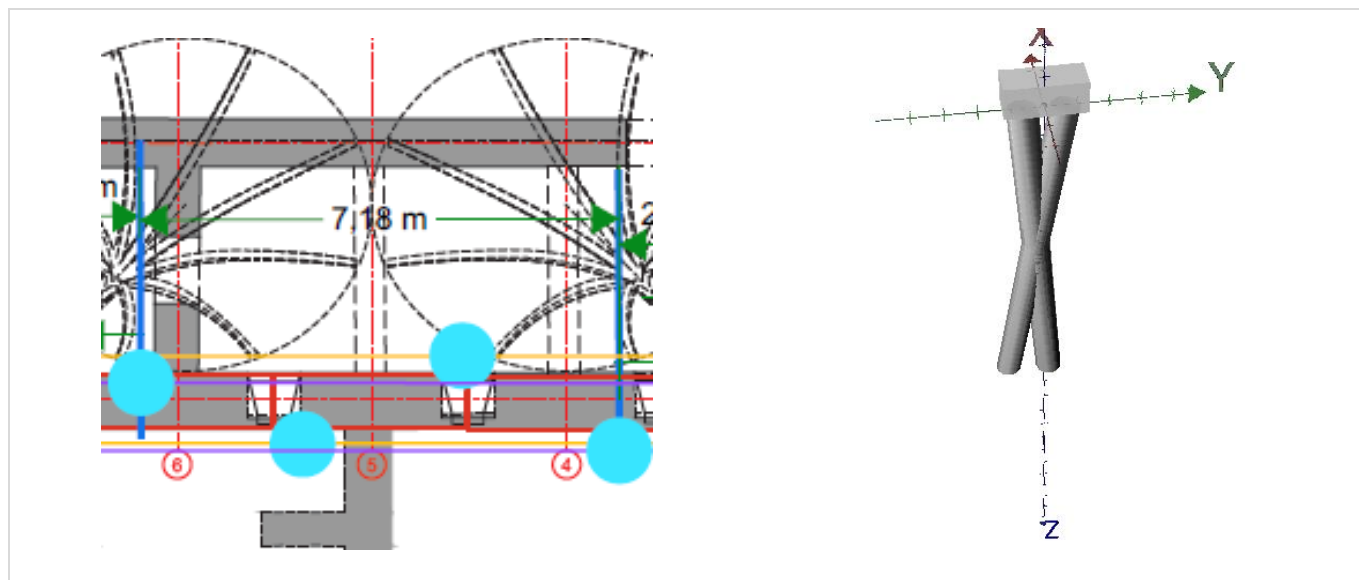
Calepinage des colonnes de jet grouting et modèle linéarisé de la fondation de la façade contemporaine au droit des zones hors influence des poteaux inclinés 1001 à 1006
